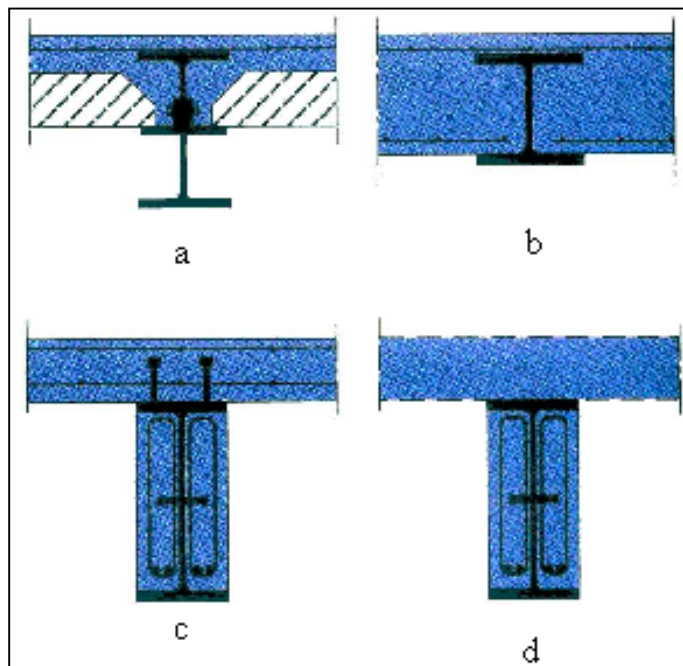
Seções de vigas mistas aço-concreto utilizadas.
